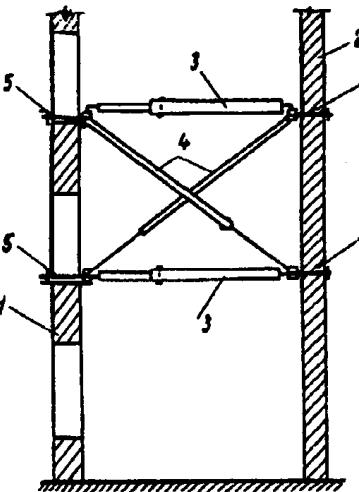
Вертикальные инвентарные стальные связи временного крепления стен:
